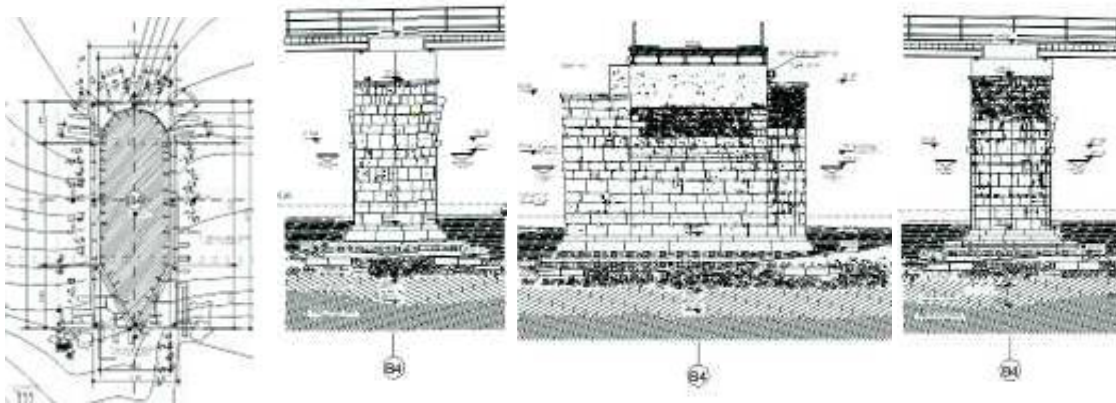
Rölöve vaziyet planı (Sert vd. 2009).
